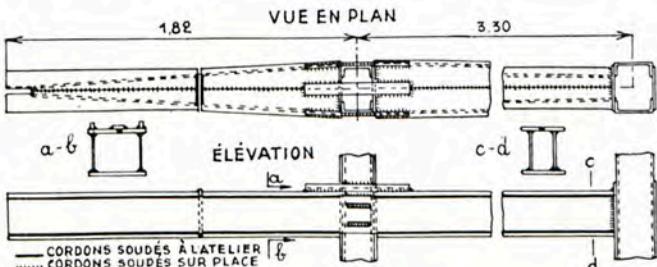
Poutre en forme de bateau supportant l'escalier.
